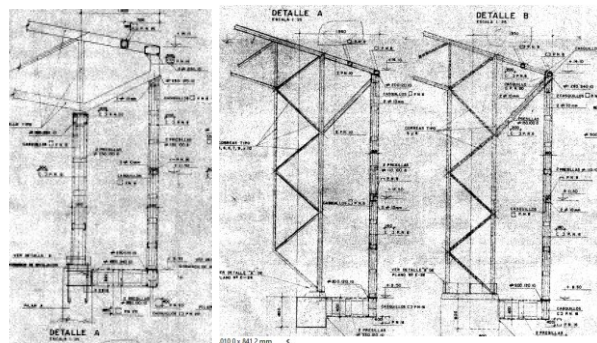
Apoyos de los pares de cubierta en los pilares perimetrales.
